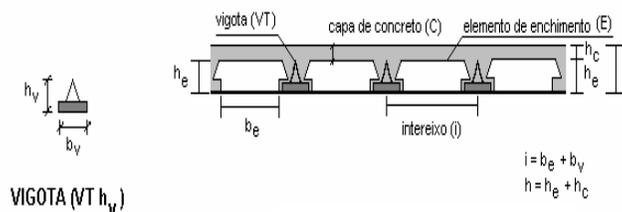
Seção transversal típica das laje com vigotas treliçadas. Fonte: ABNT NBR 14859-1:2002.
